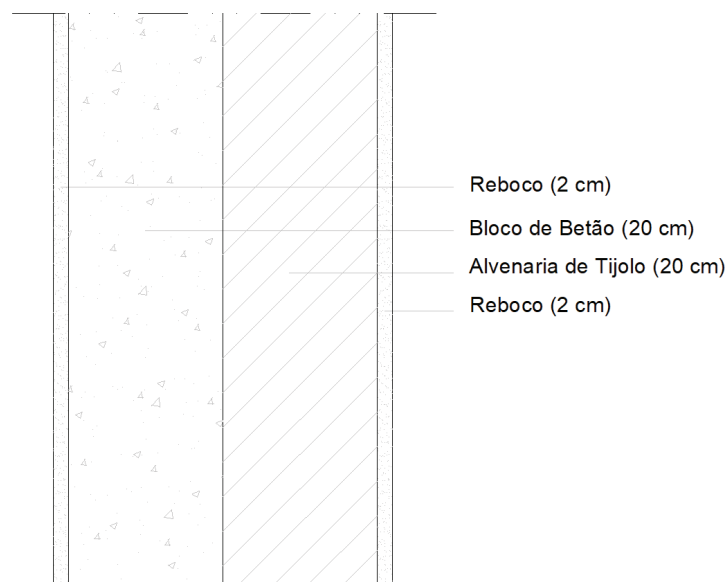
Pormenor construtivo da parede interior tipo II (elevador)
